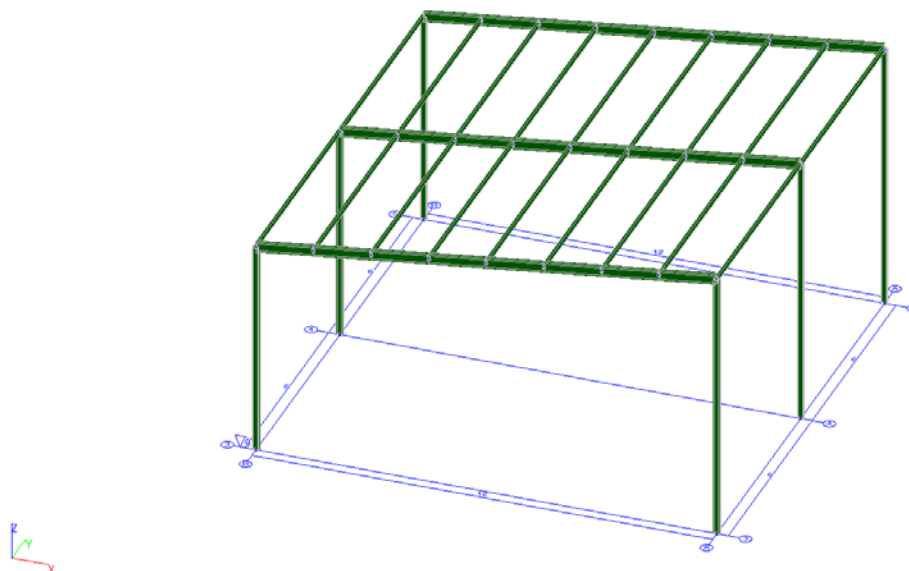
Расчётная схема поперечной рамы здания (Каркас блока в осях 3-5/А-В с объёмом элементов)
